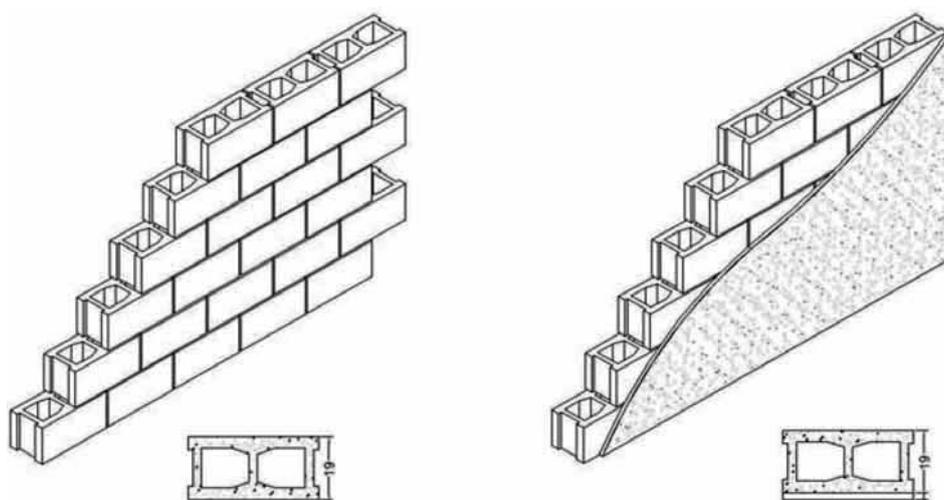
[Izquierda]: Muro de 1 hoja de bloque de hormigón. [Derecha]: Muro de 1 hoja de bloque de hormigón enfoscado.
